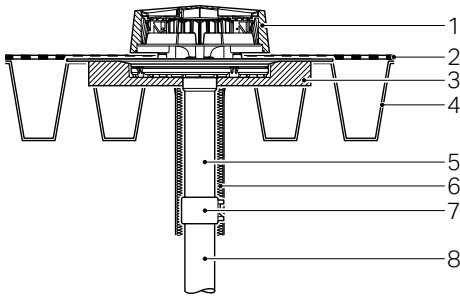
Aufbau Leichtdach mit Geberit Pluvia Folienkörper
